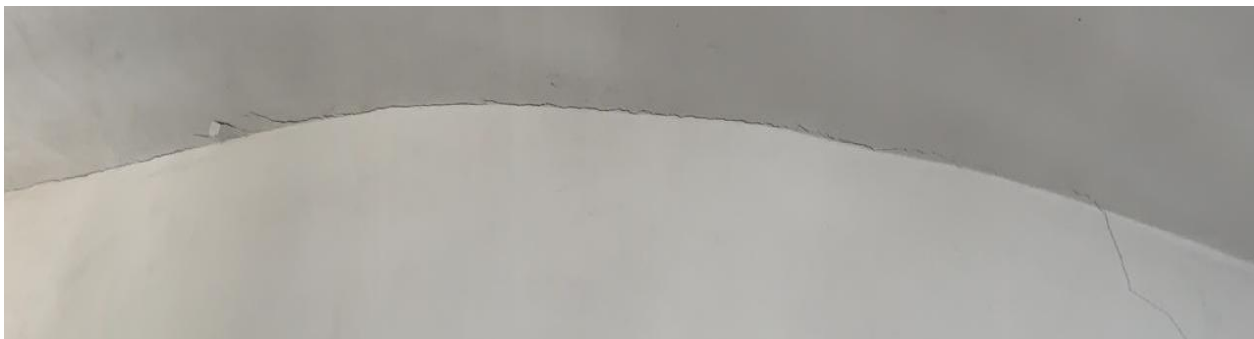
Fisura discontinuidad por junta baño de mujeres
